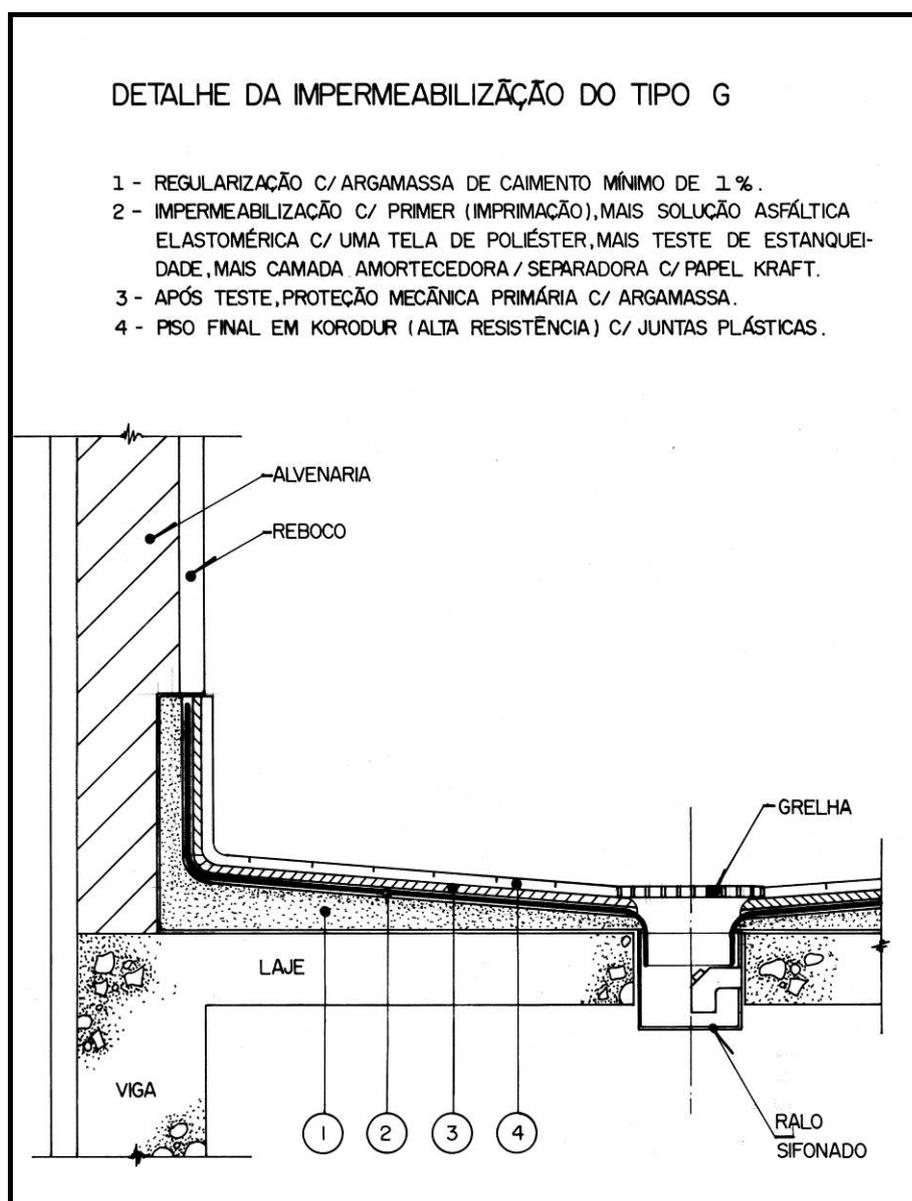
Detalhe de impermeabilização tipo G utilizando solução asfáltica elastomérica estruturada (PROMON, 1992 apud JORDY, 2002).
